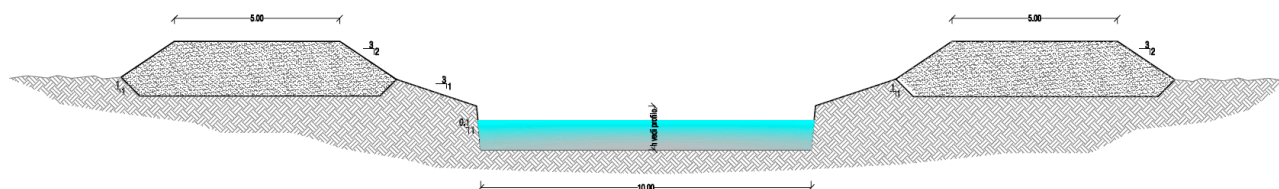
Sezione lama Scorbeto tratto arginato
